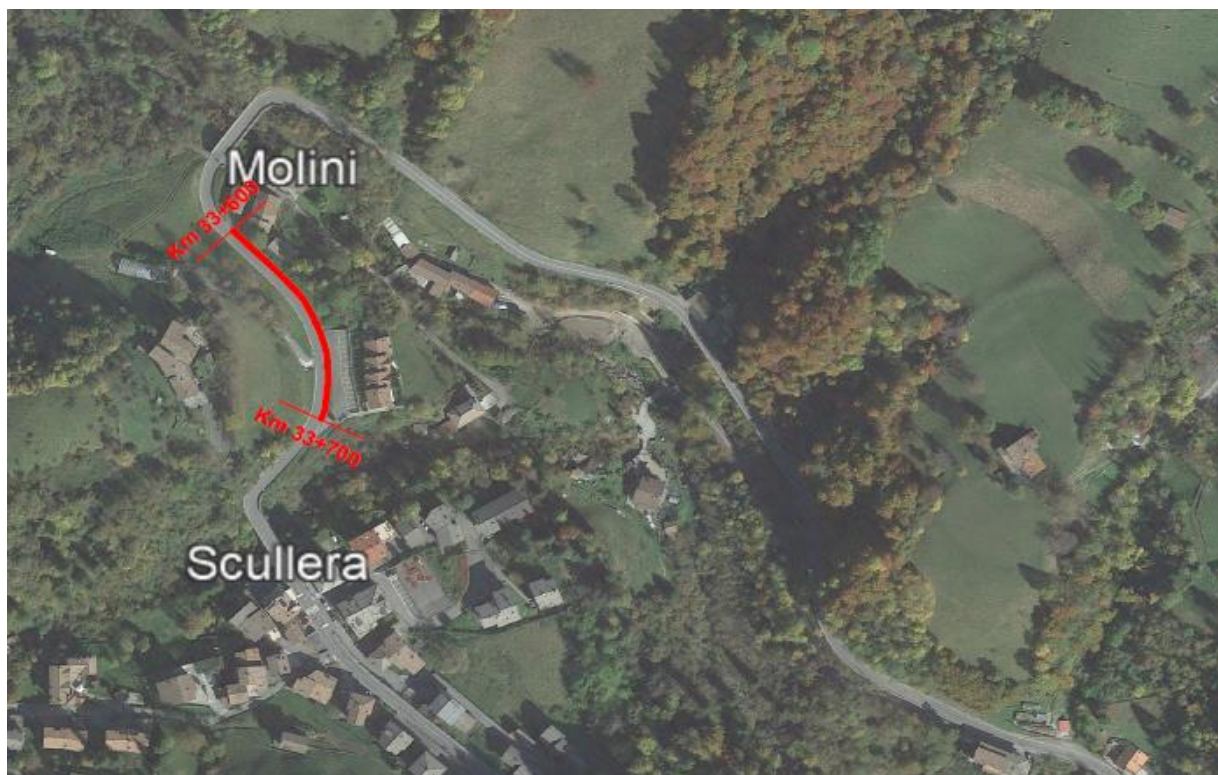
Inquadramento planimetrico tratta interessata dall'ispezione
